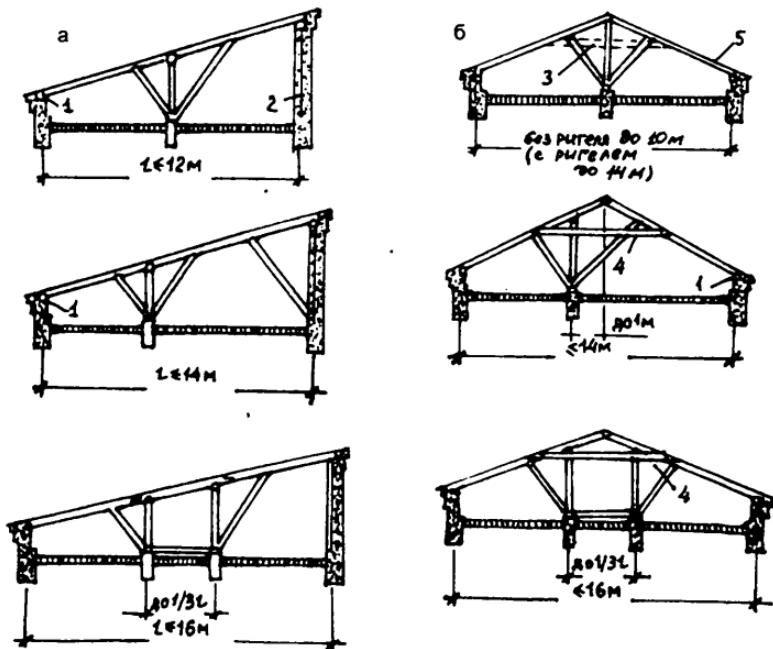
Схемы скатных крыш с деревянными наслонными стропилами:
